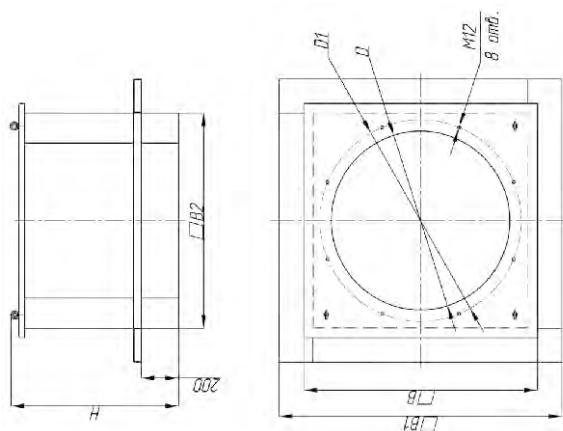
Габаритные и присоединительные размеры квадратных стаканов для крышных вентиляторов.
